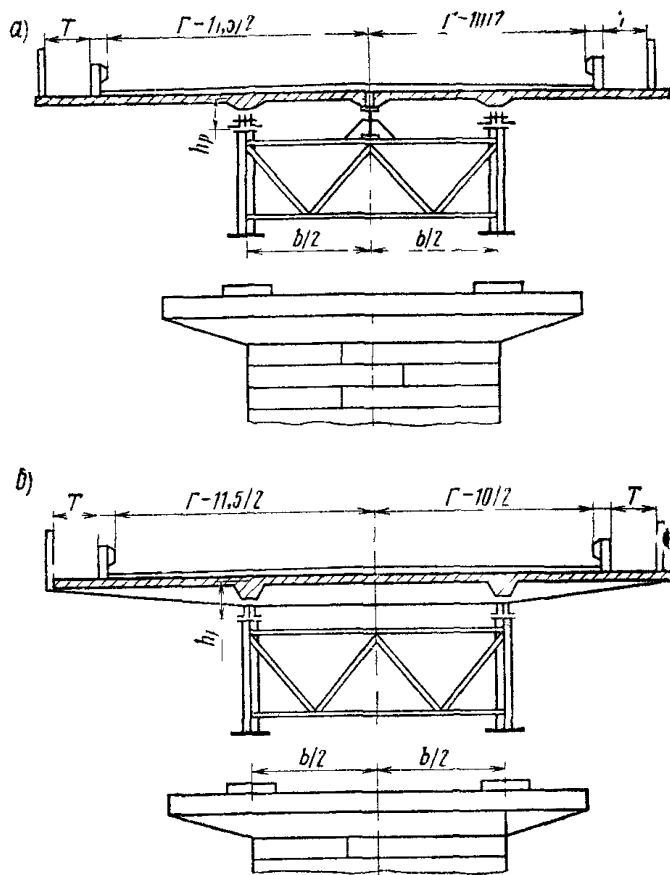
Схемы уширения сталежелезобетонных пролетных строений со сплошной стенкой до габаритов  $\Gamma-10$  и  $\Gamma-11,5$  за счет замены железобетонных плит новыми
